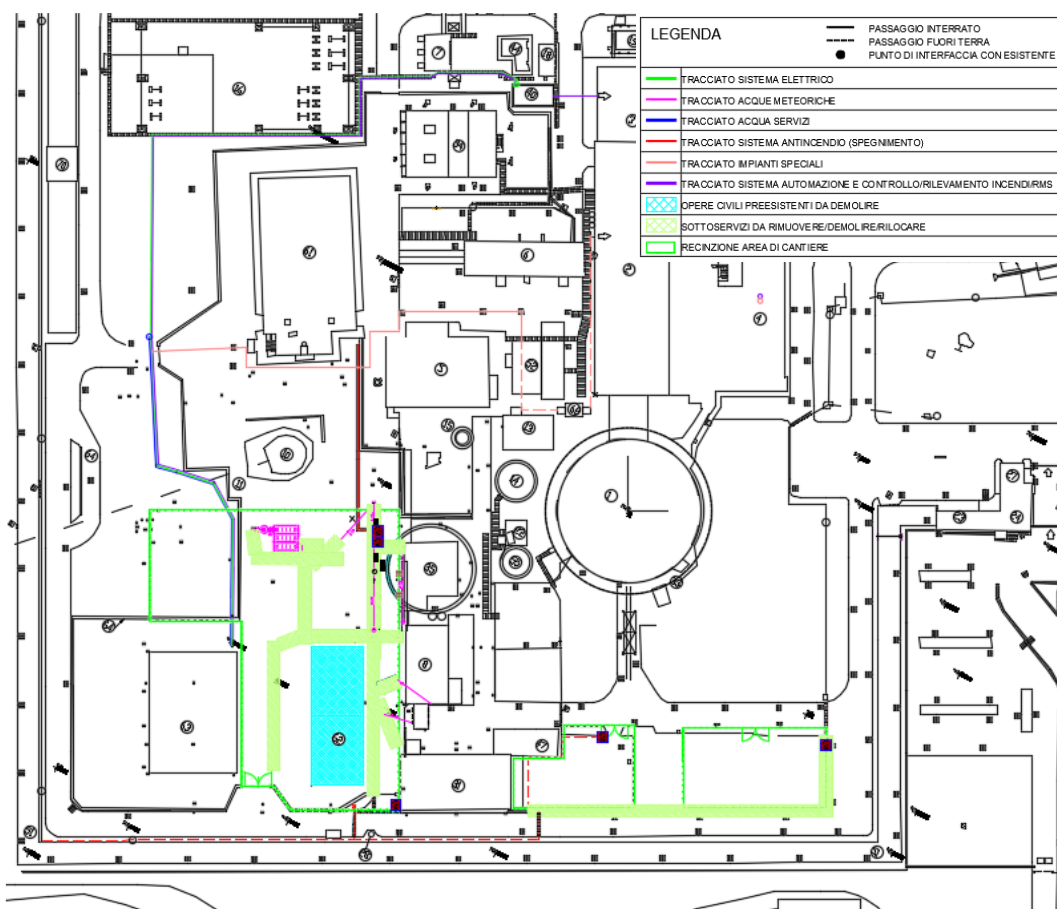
Planimetria delle interferenze (Elaborazione tratta da GRDT01331_00)
